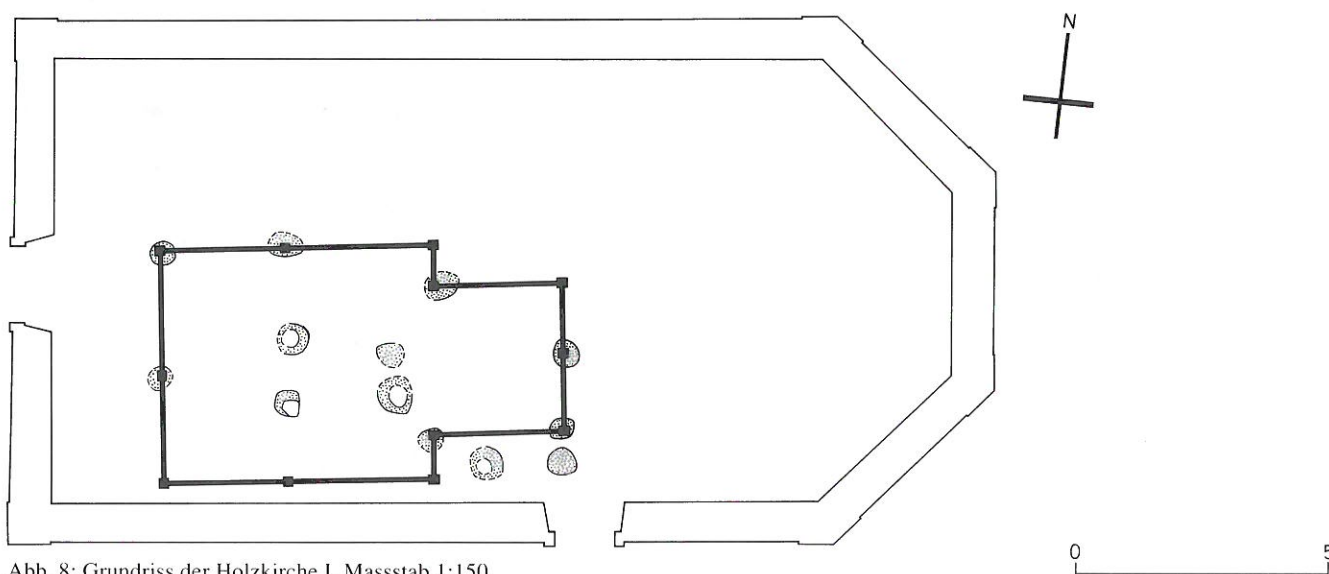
Grundriss der Holzkirche I. Massstab 1:150.
